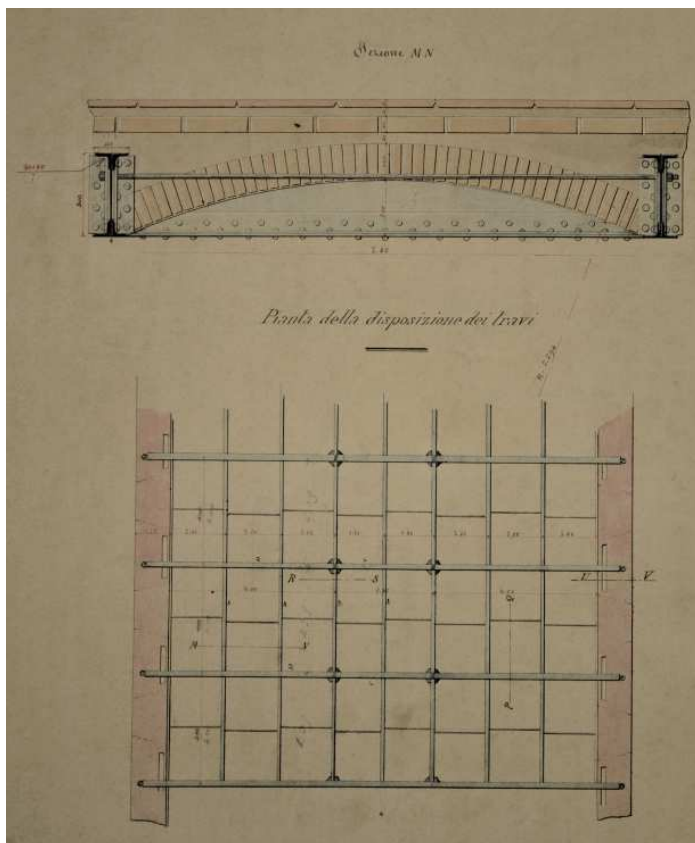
Dettaglio delle travature in acciaio nei bracci longitudinali e orditura del solaio, pianta e sezione M-N
